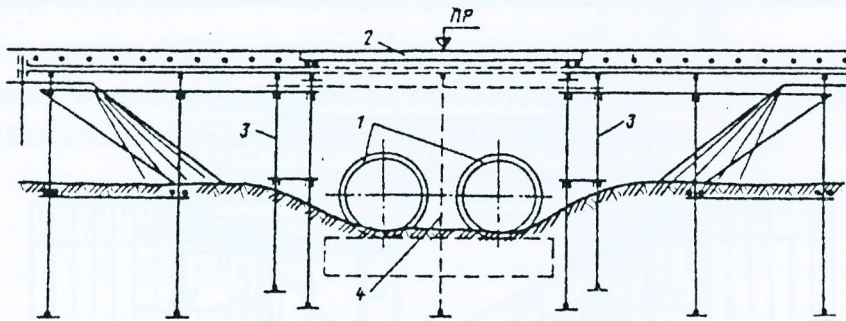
Переустройство деревянного моста в железобетонную трубу: 1 – труба; 2 – разгрузочный пакет; 3 – дополнительная опора (рама); 4 – опора моста, удаляемая до сооружения трубы.
